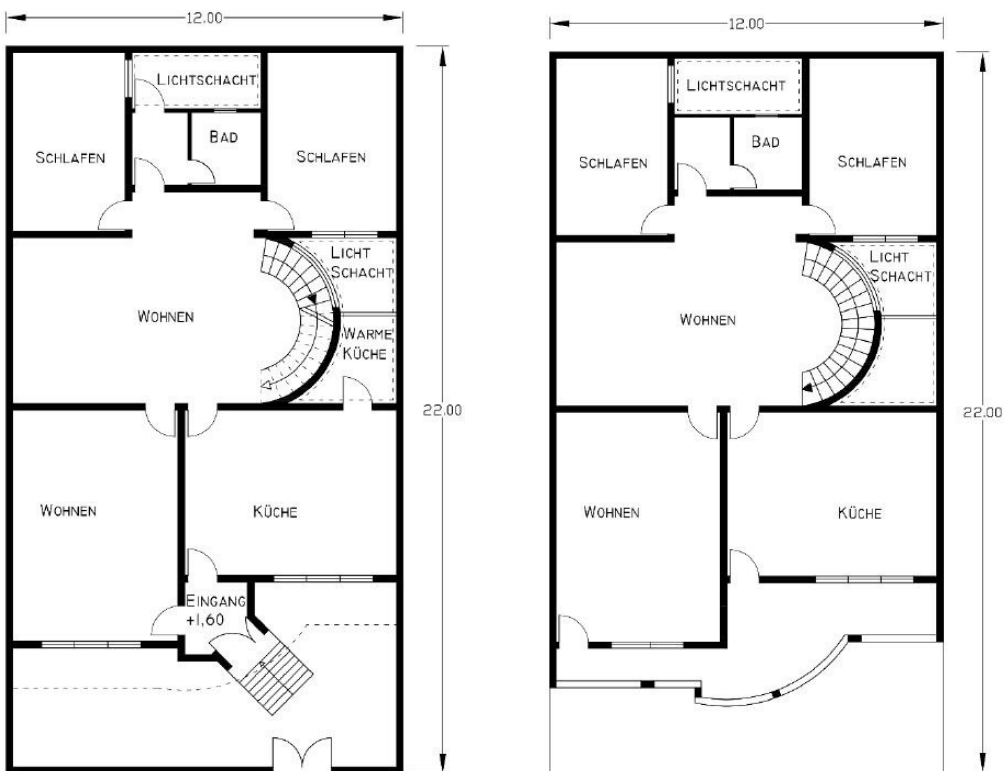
Grundriss EG (links) und Grundriss 1. OG (rechts)²¹⁴
